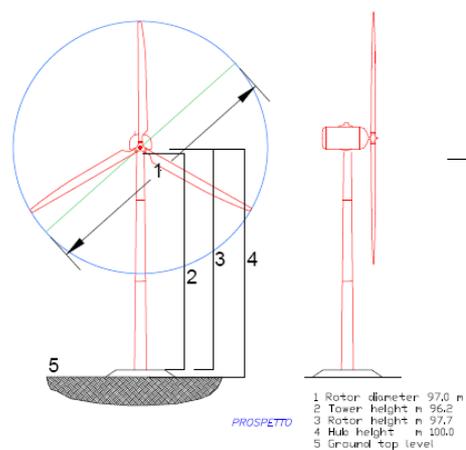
Prospetto e sezione dell'aerogeneratore
